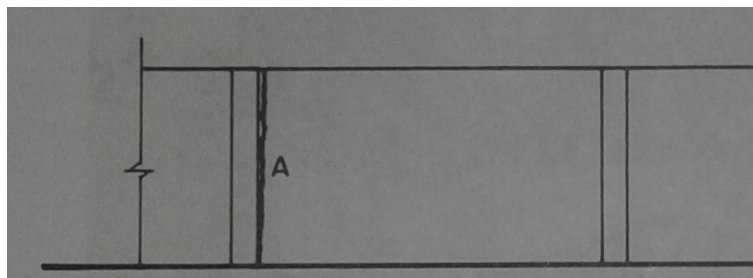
Trinca em muros – destacamento entre alvenaria e pilar.
